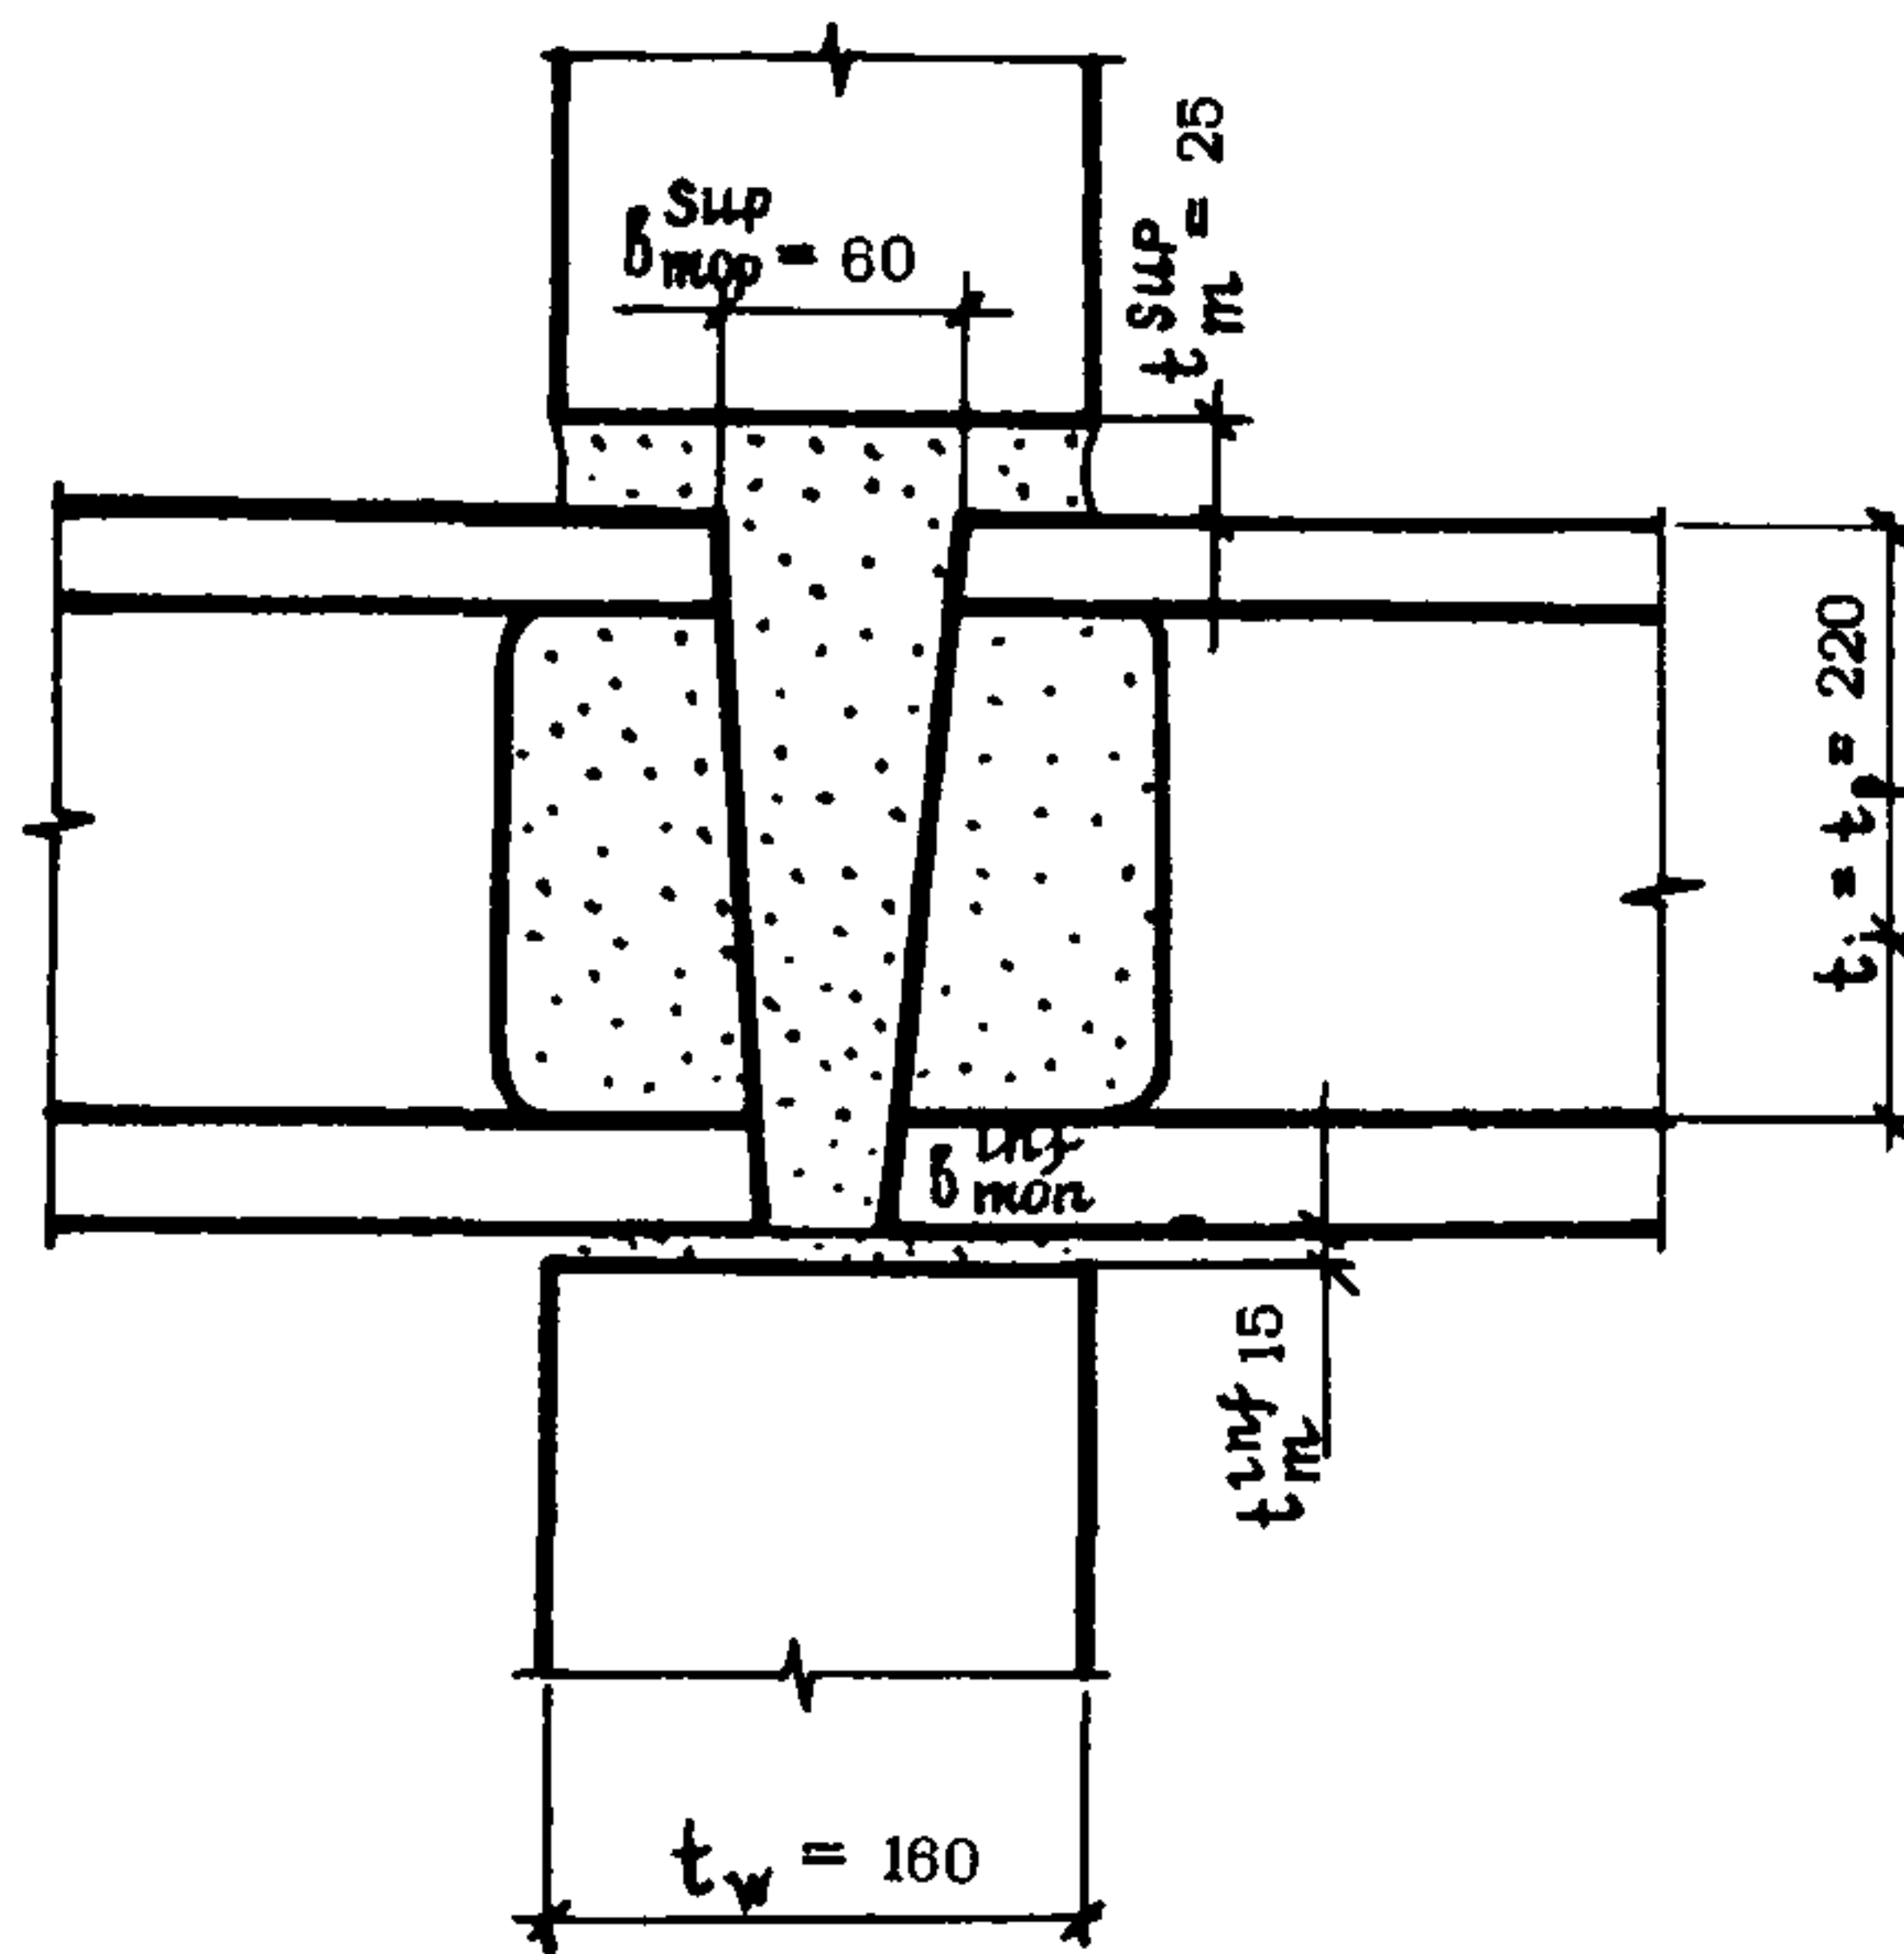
Платформенный монолитный стык внутренней панельной стены при двустороннем опирании плит перекрытий (к примеру 8)
